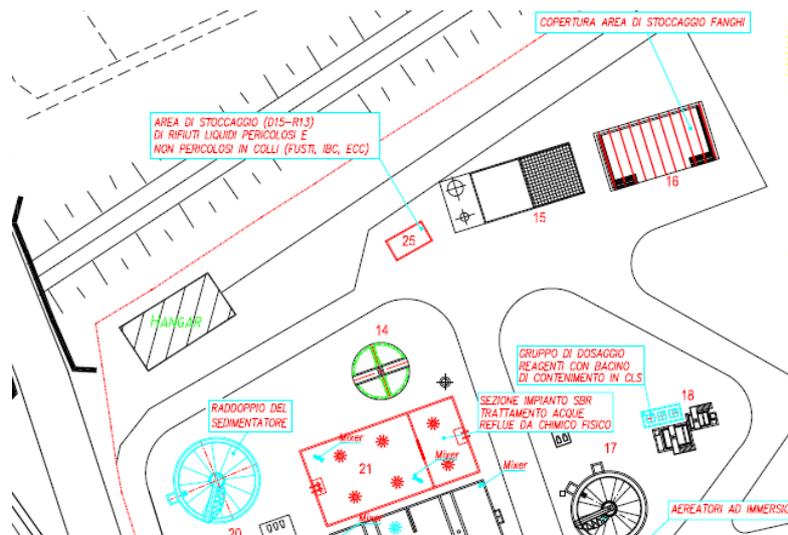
stralcio planimetrico area di stoccaggio rifiuti in colli
